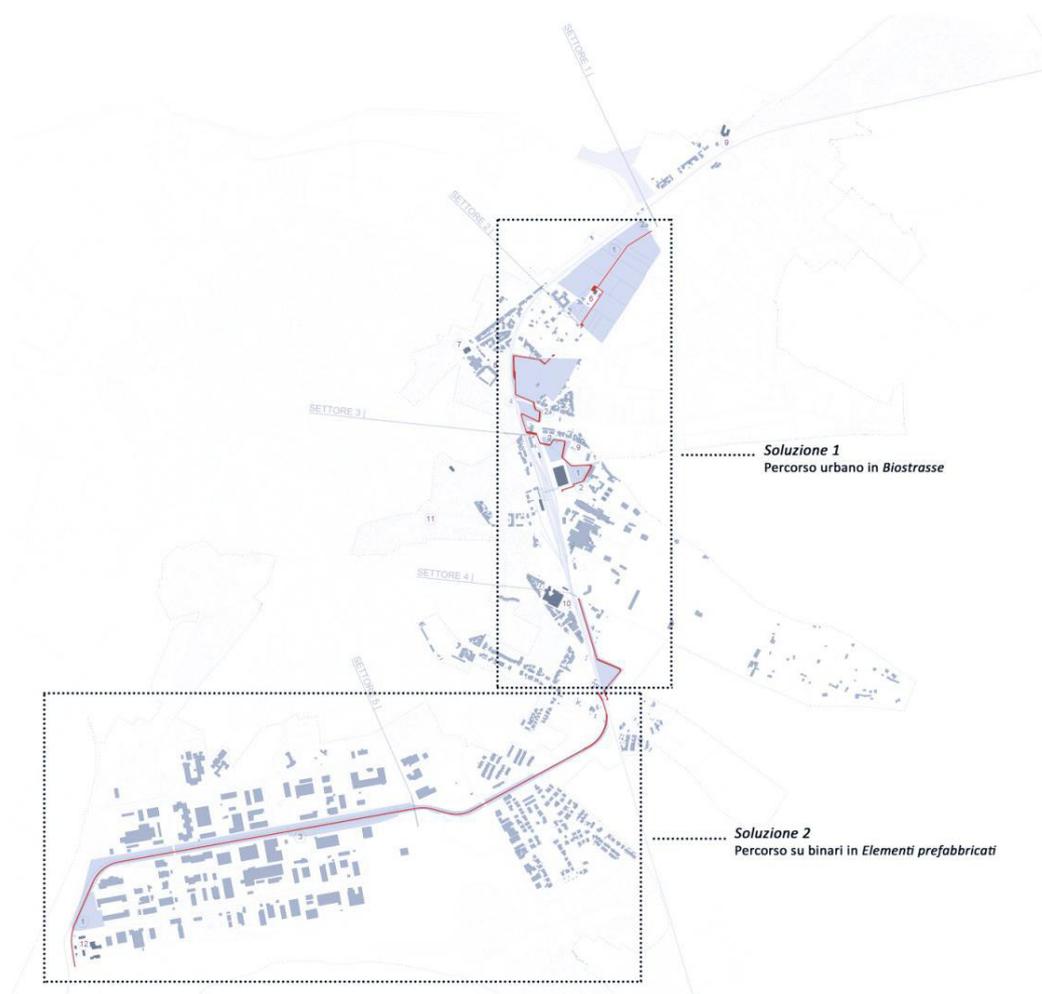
Soluzioni tecniche adottate: individuazione planimetrica delle aree di applicazione
